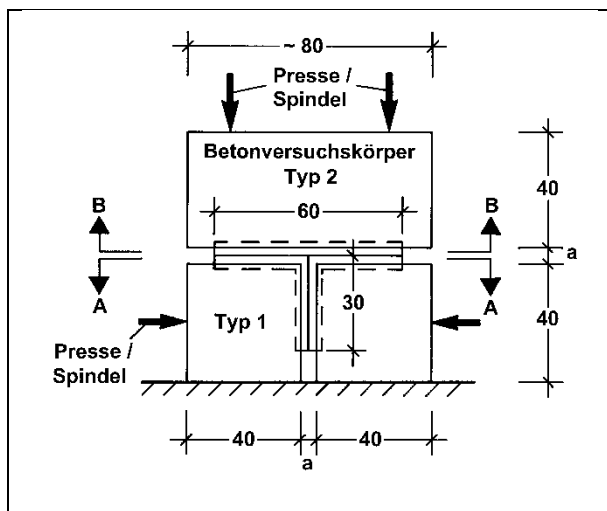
Betonprüfkörper für den Abplatzversuch (Seitenansicht)
